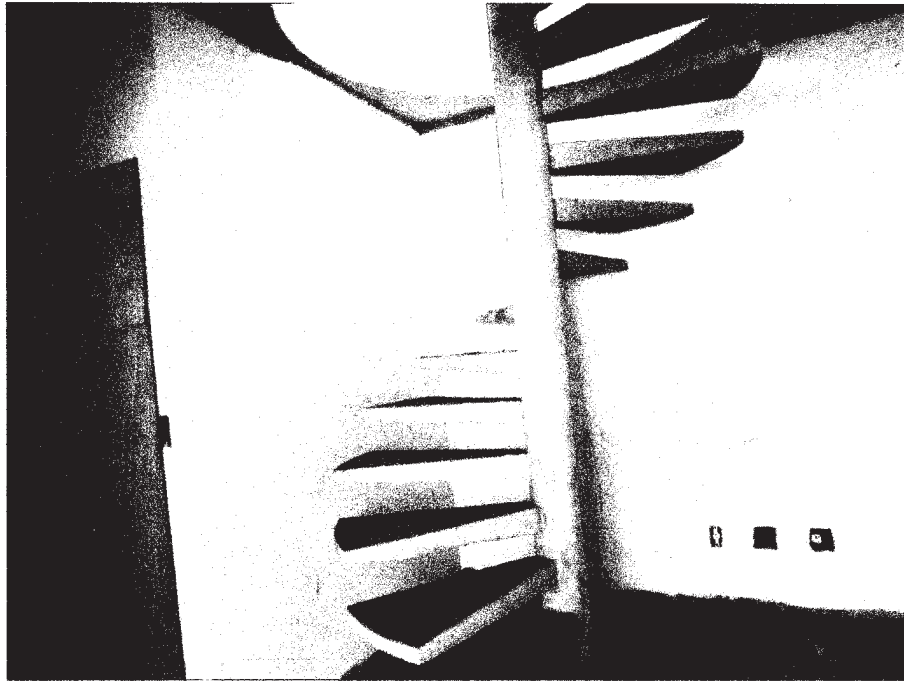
Vista da escada caracol de acesso aos pavimentos do imóvel.
